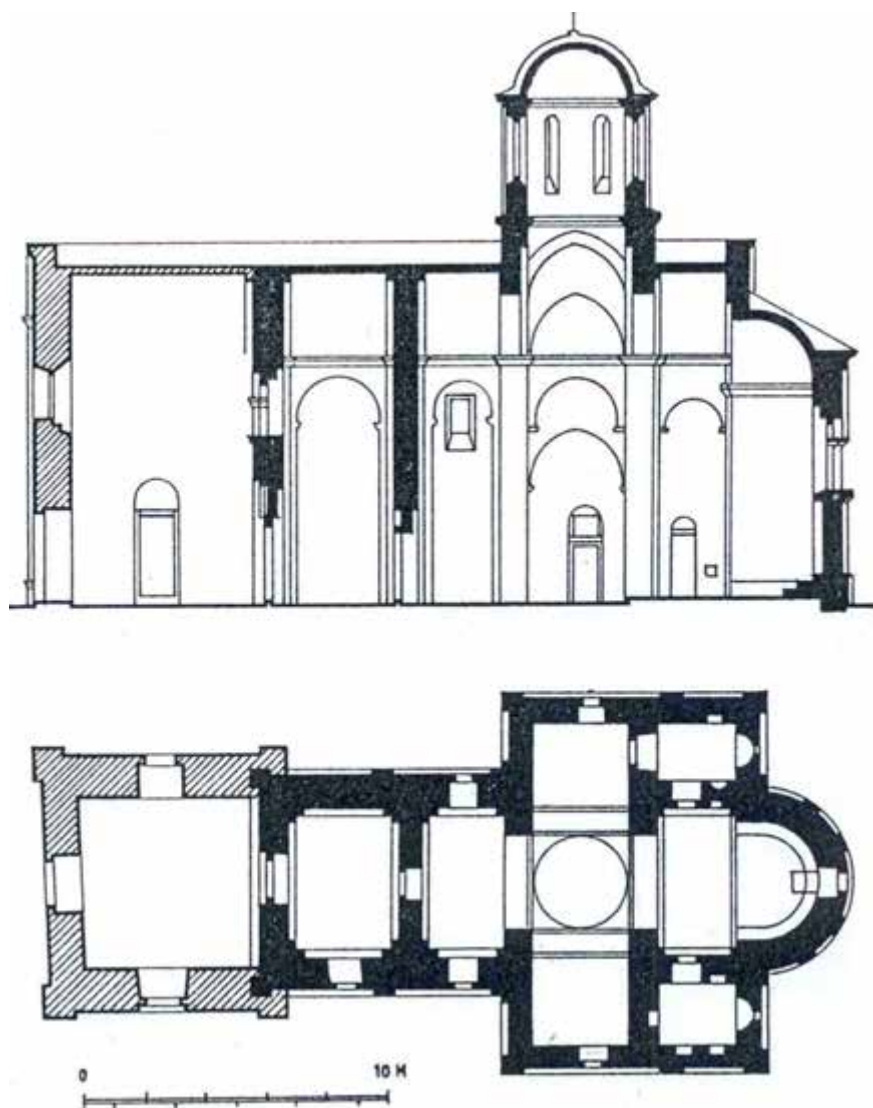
Sant' Achille, pianta e sezione longitudinale, Arilje (da Nenadović 1980)
